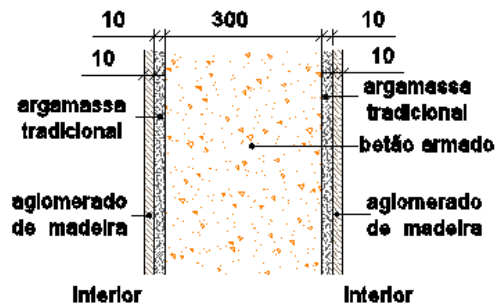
Pormenor das paredes da envolvente interior – PI2
